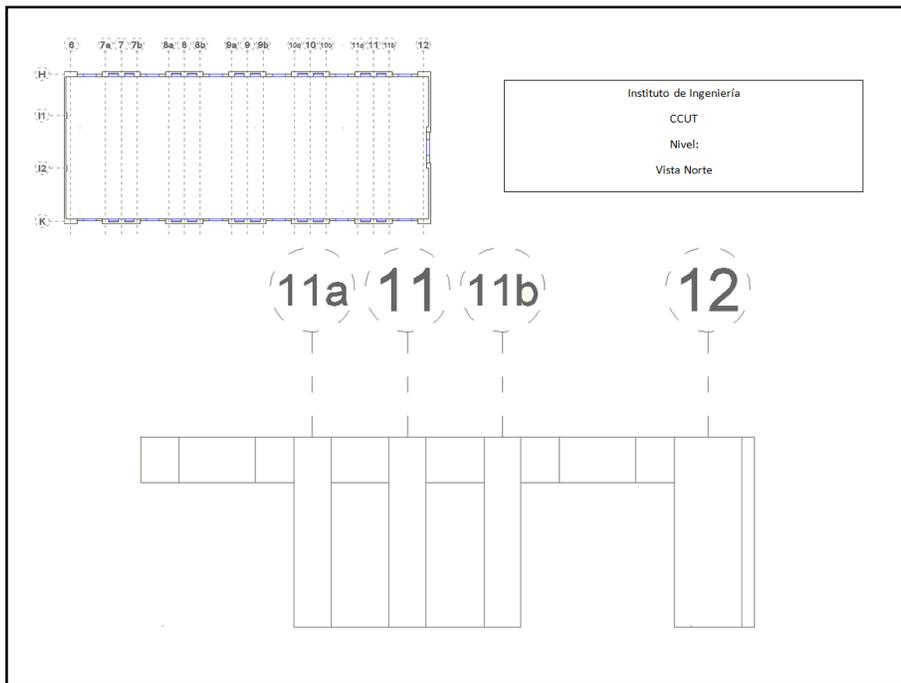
Elevación de columnas, muros y trabes, sobre eje H entre eje 10b y 12
